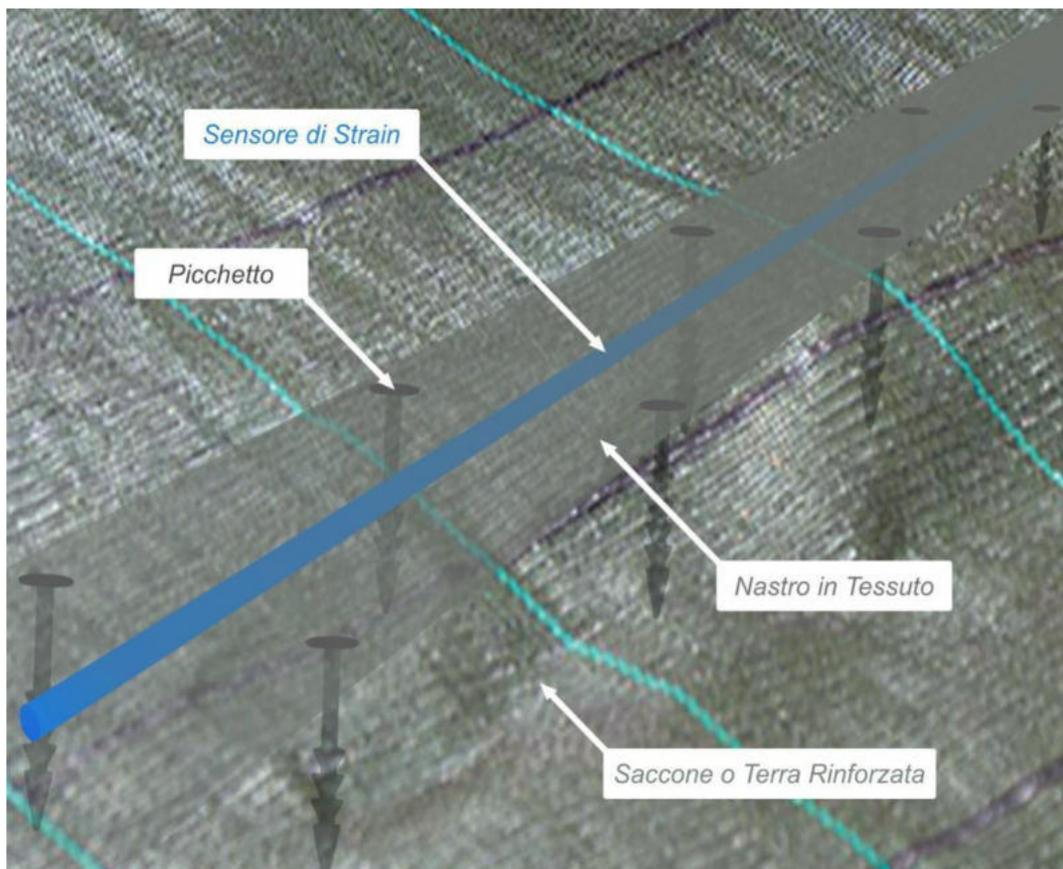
Modalità di fissaggio del tessuto sensorizzato
